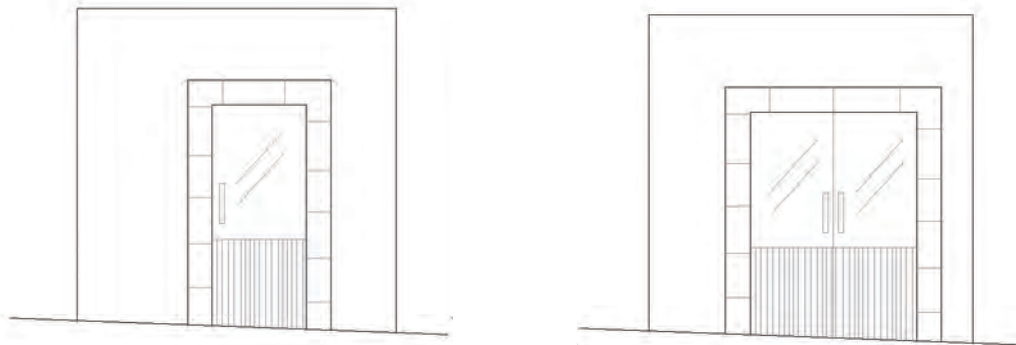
26. 1966. AMPLIACIÓN DE PUERTA DE ACCESO A LOCAL EN PLANTA BAJA. ESTADO ANTERIOR Y REFORMADO
